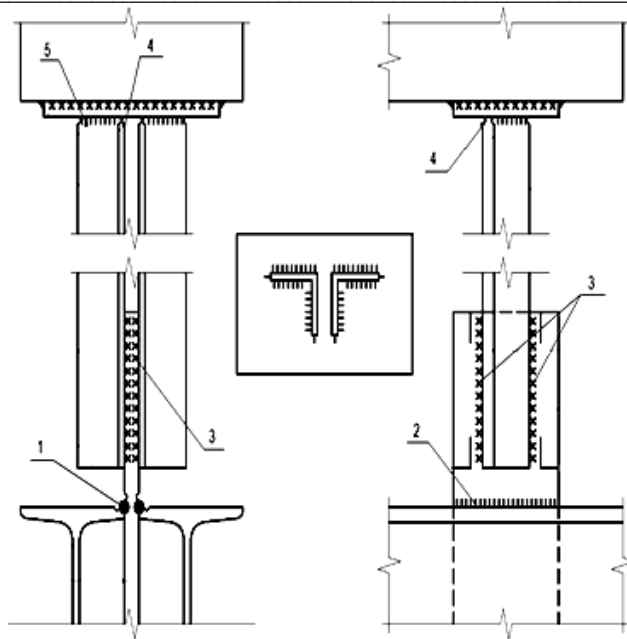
Варианты разрушения узла сопряжения подвески с радиальной балкой: 1 — разрыв фасонки, ослабленной подрезами основного металла глубиной 1 мм; 2 — отрыв фасонки срезом металла сварных швов; 3 — отрыв уголков от фасонки срезом металла сварных швов; 4 — разрыв уголков ослабленных подрезами основного металла; 5 — отрыв уголков от опоры срезом металла сварных швов
